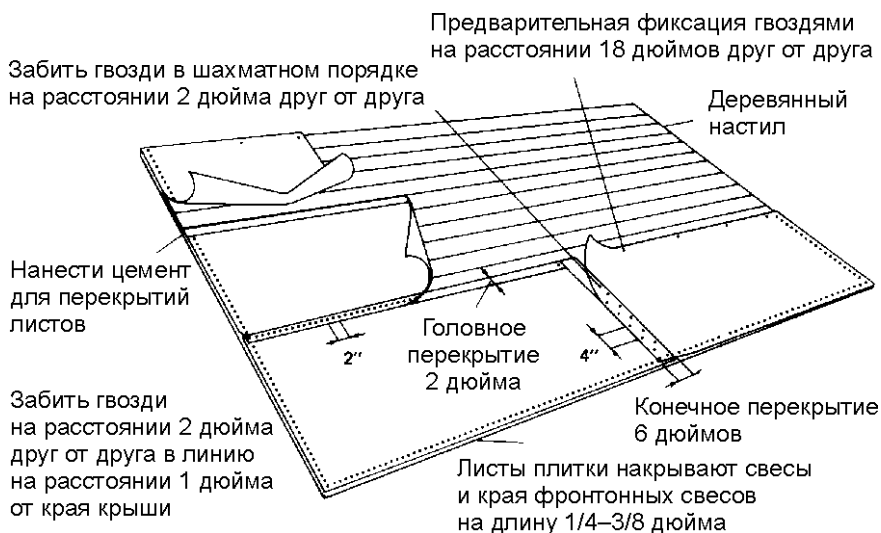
Укладка рулонных кровельных материалов с использованием метода открытых гвоздей (параллельно свесам) (Bird and Son)
